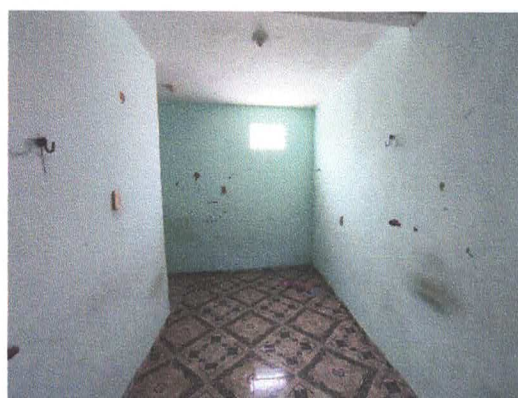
Sala Vedada por PVC do Pavimento Superior
